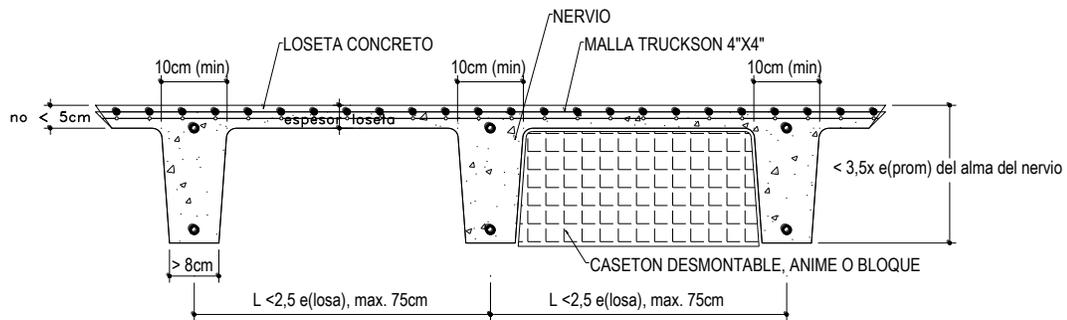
Planta de envidado de entrepiso. Losa nervada en una dirección. Con Bloques de anime (Town Houses). Nota. Bonucci (2012).
